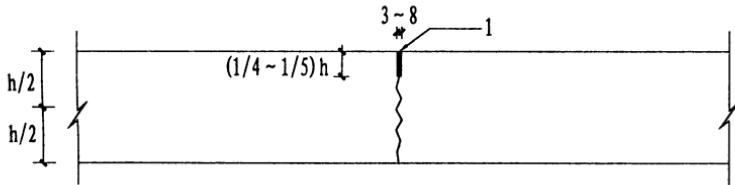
不设传力杆假缝型横向缩缝构造(尺寸单位:mm)
